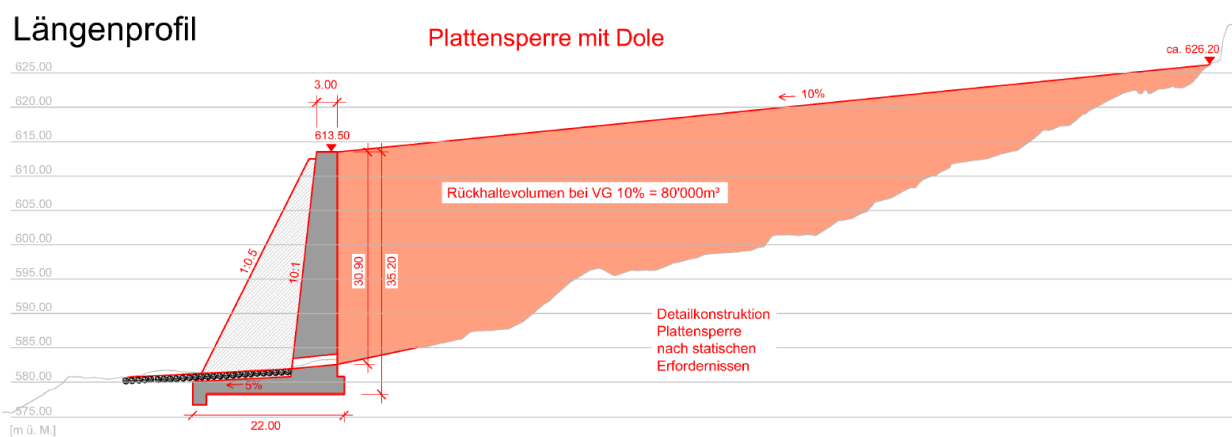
Projektiertes Rückhaltebauwerk bei km 0+937, Längenprofil
